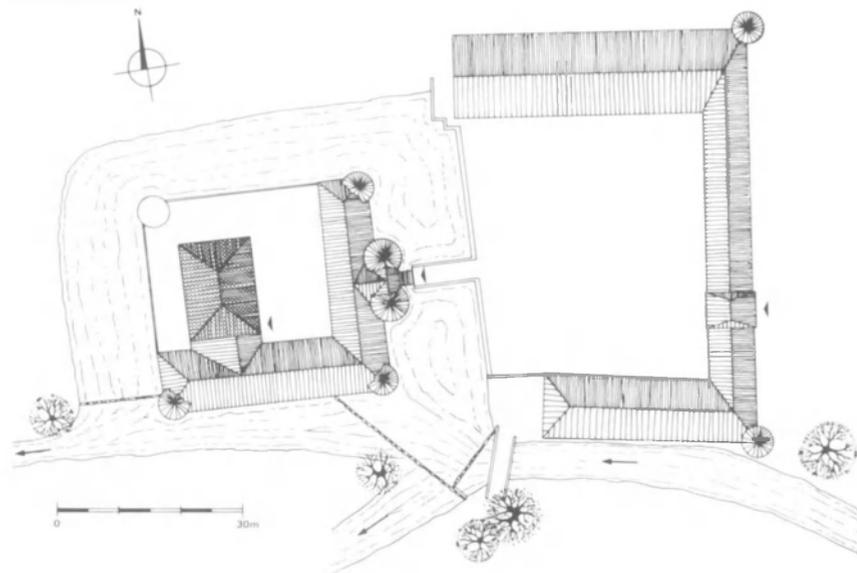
Spontin. Plan-masse du château et de la ferme, partiellement d'après F. Bonaert. Le donjon apparaît en grisé.
